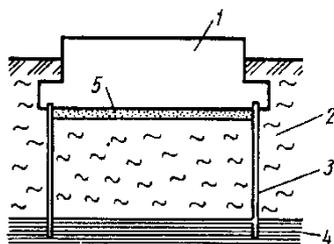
Усиление основания с помощью шпунтового ограждения:
